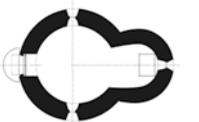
Grundriss Wetschko/Klinar 1978. M 1:400.
